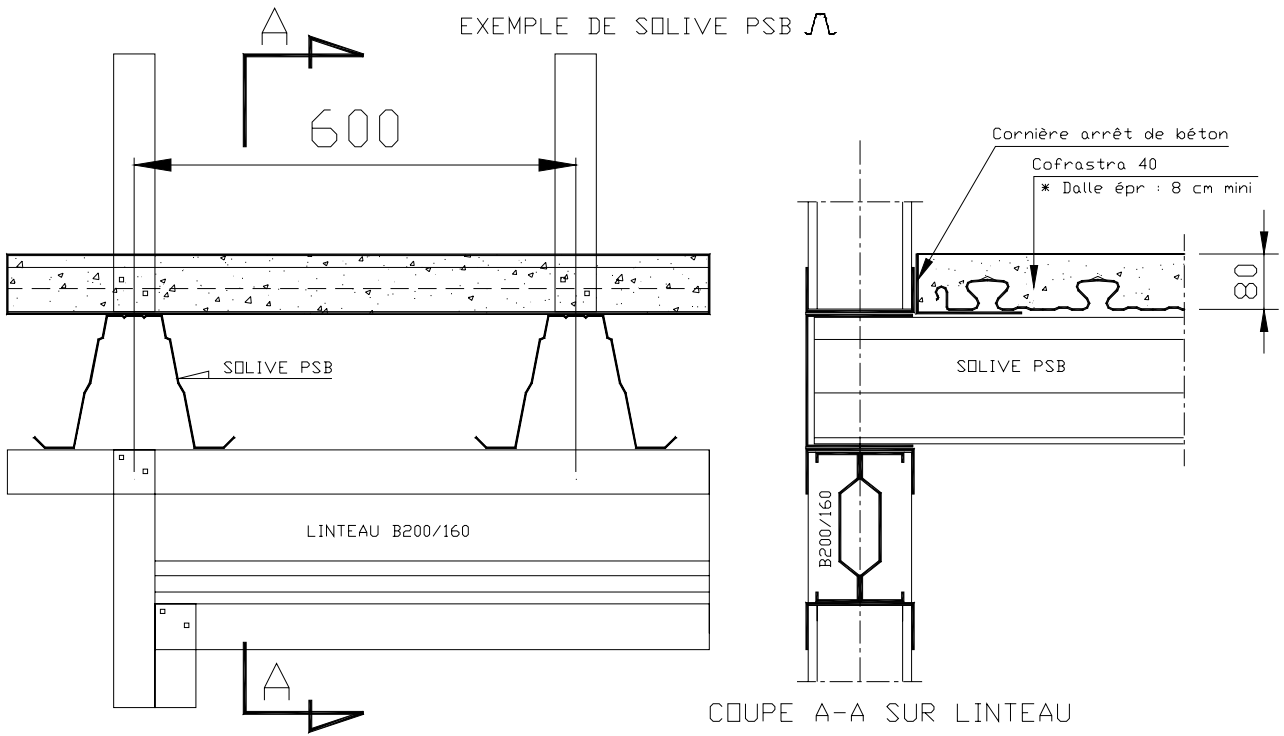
Plancher collaborant et coffrage perdu – Coupe A-A sur linteau
